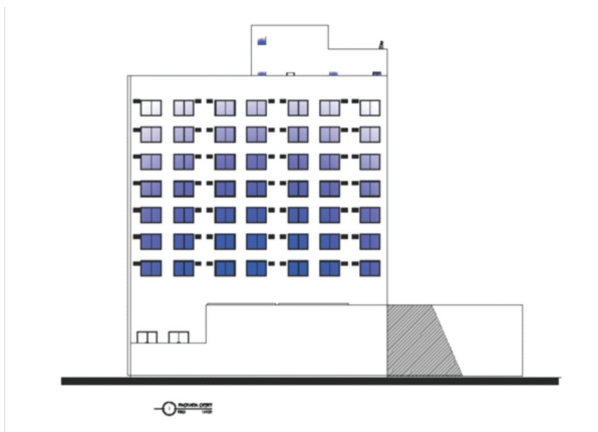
Fachada oeste, Hotel Jacques George Tower, Vega Amaral.
